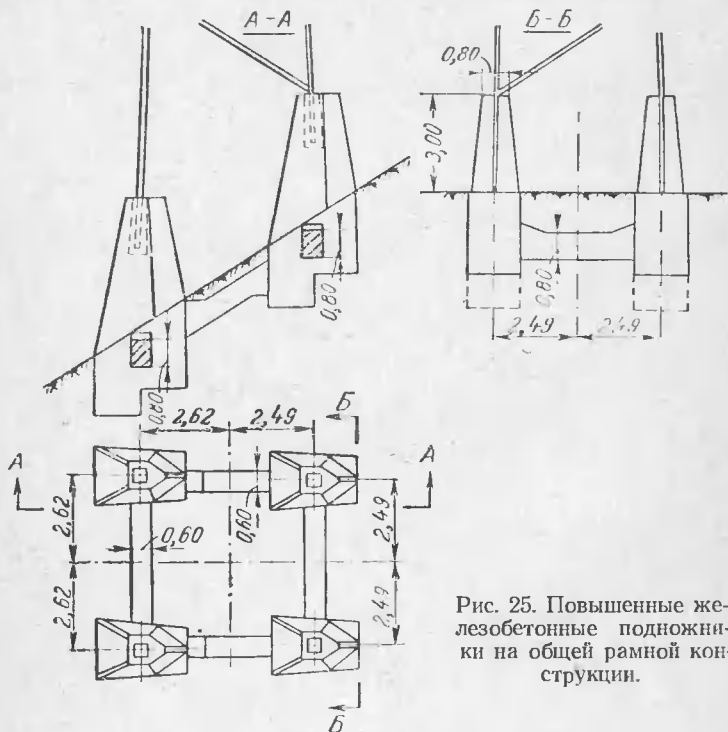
Повышенные железобетонные подножки на общей рамной конструкции.
